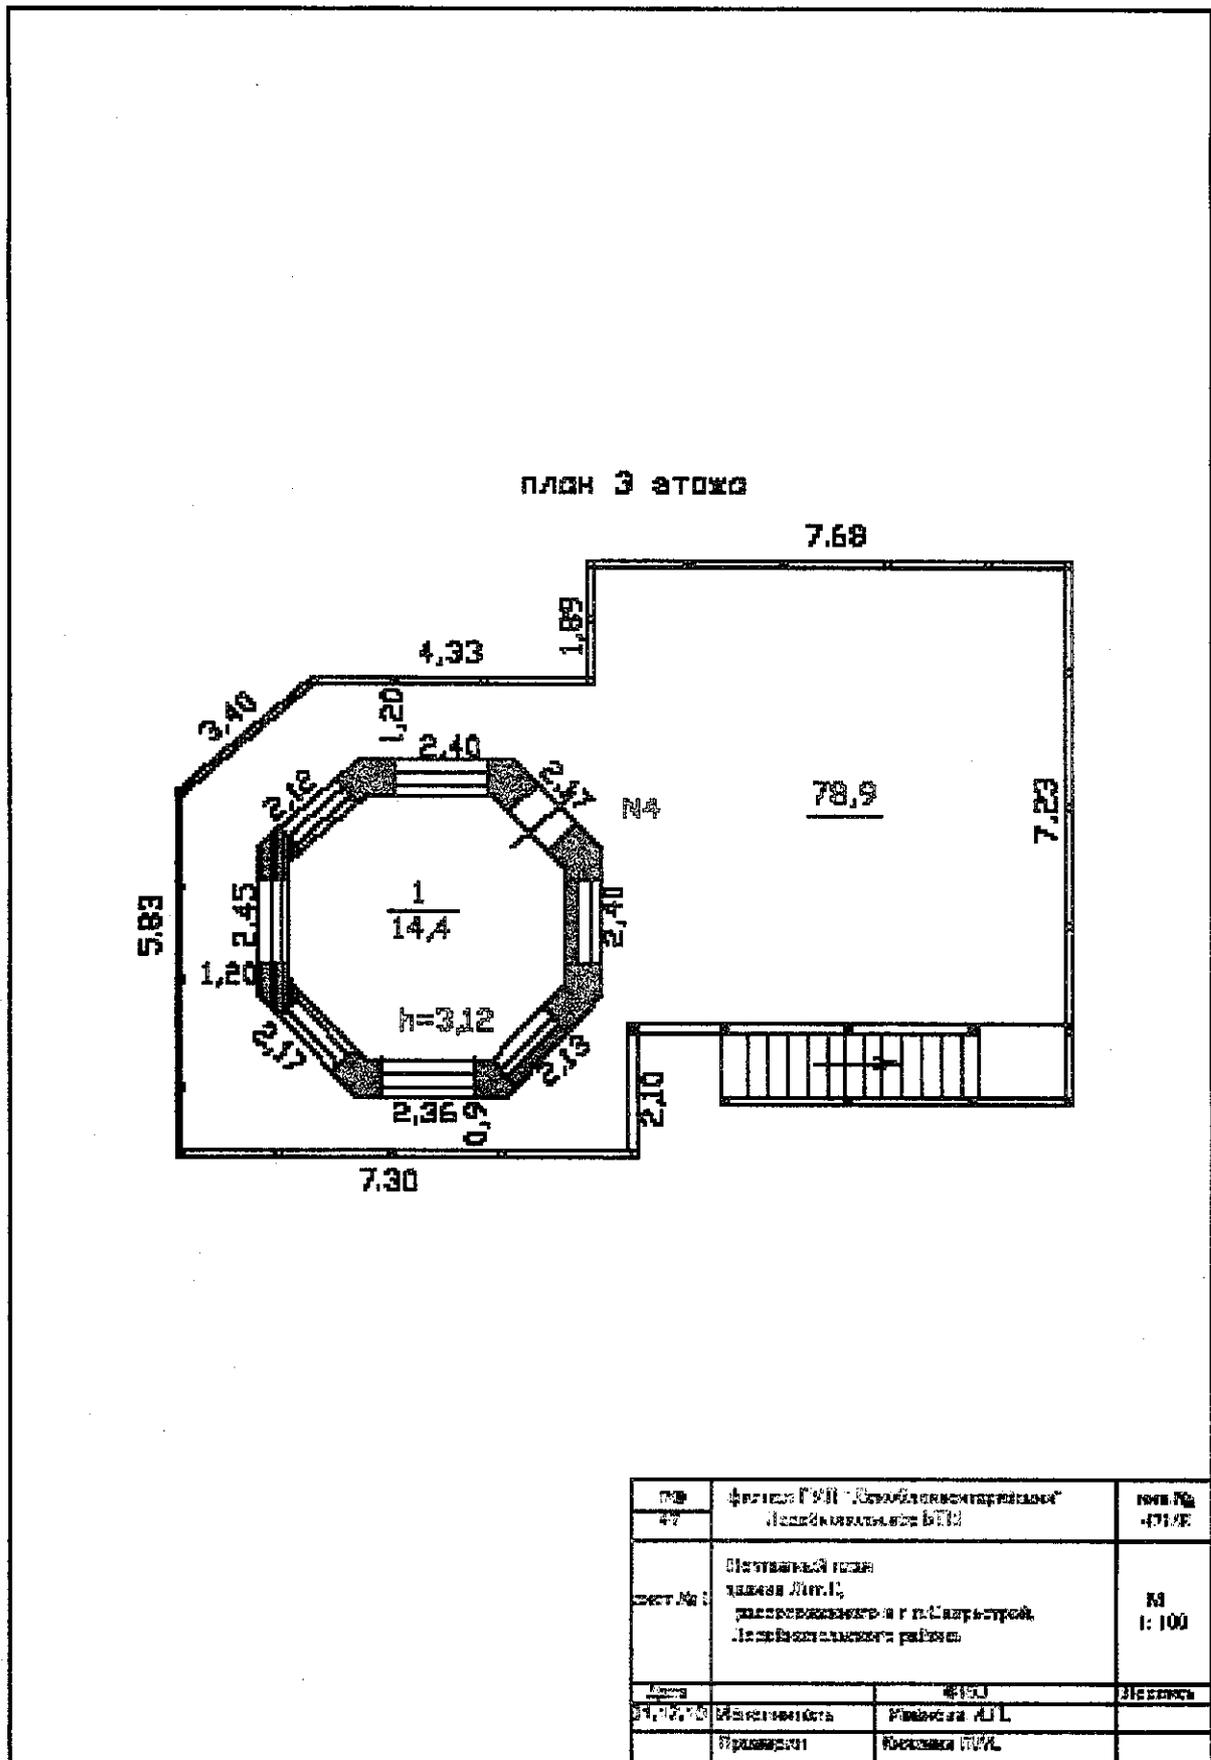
поэтажный план здания Лит. Е (3 этаж)
